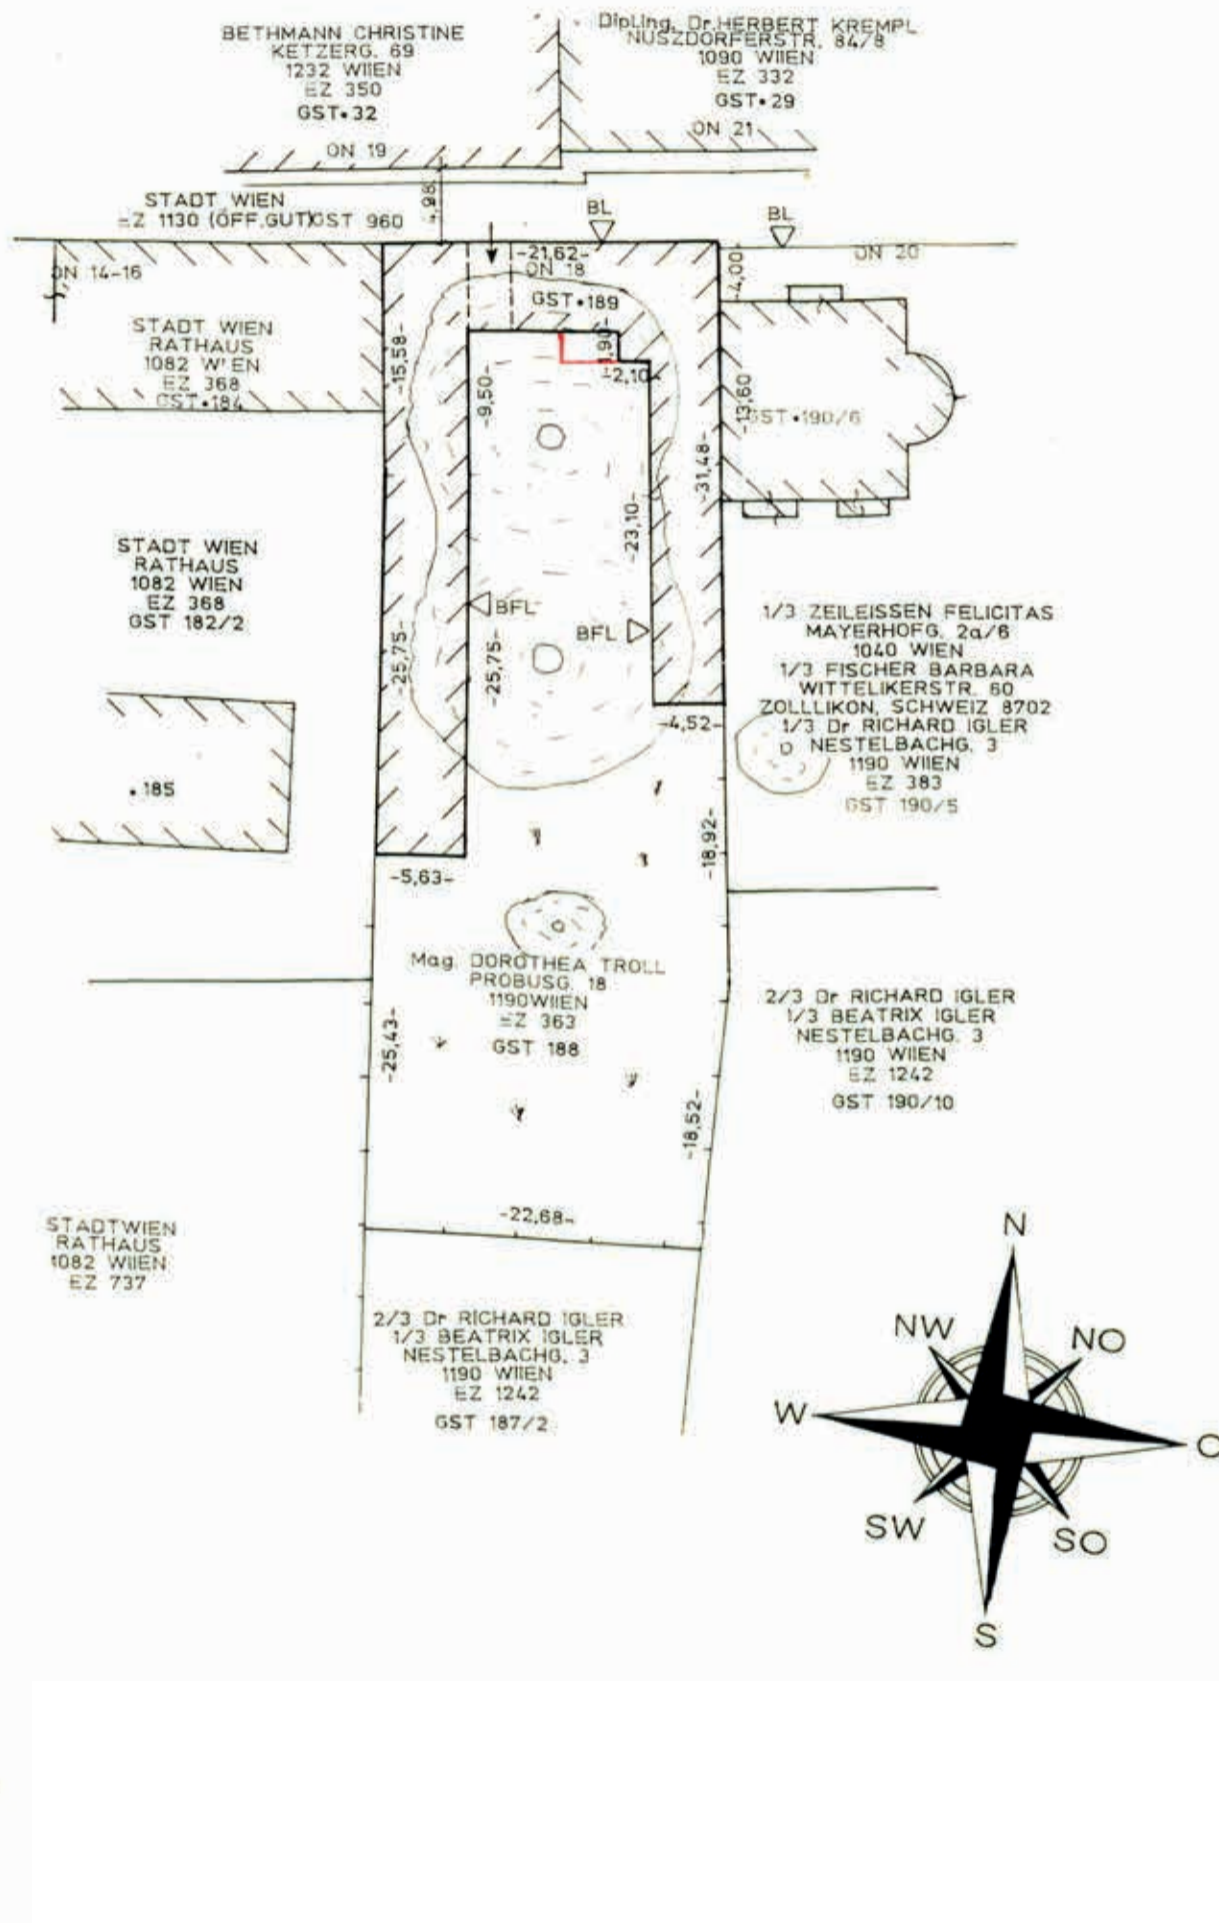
Einreichplan | Lageplan | M 1:500 | 1993
